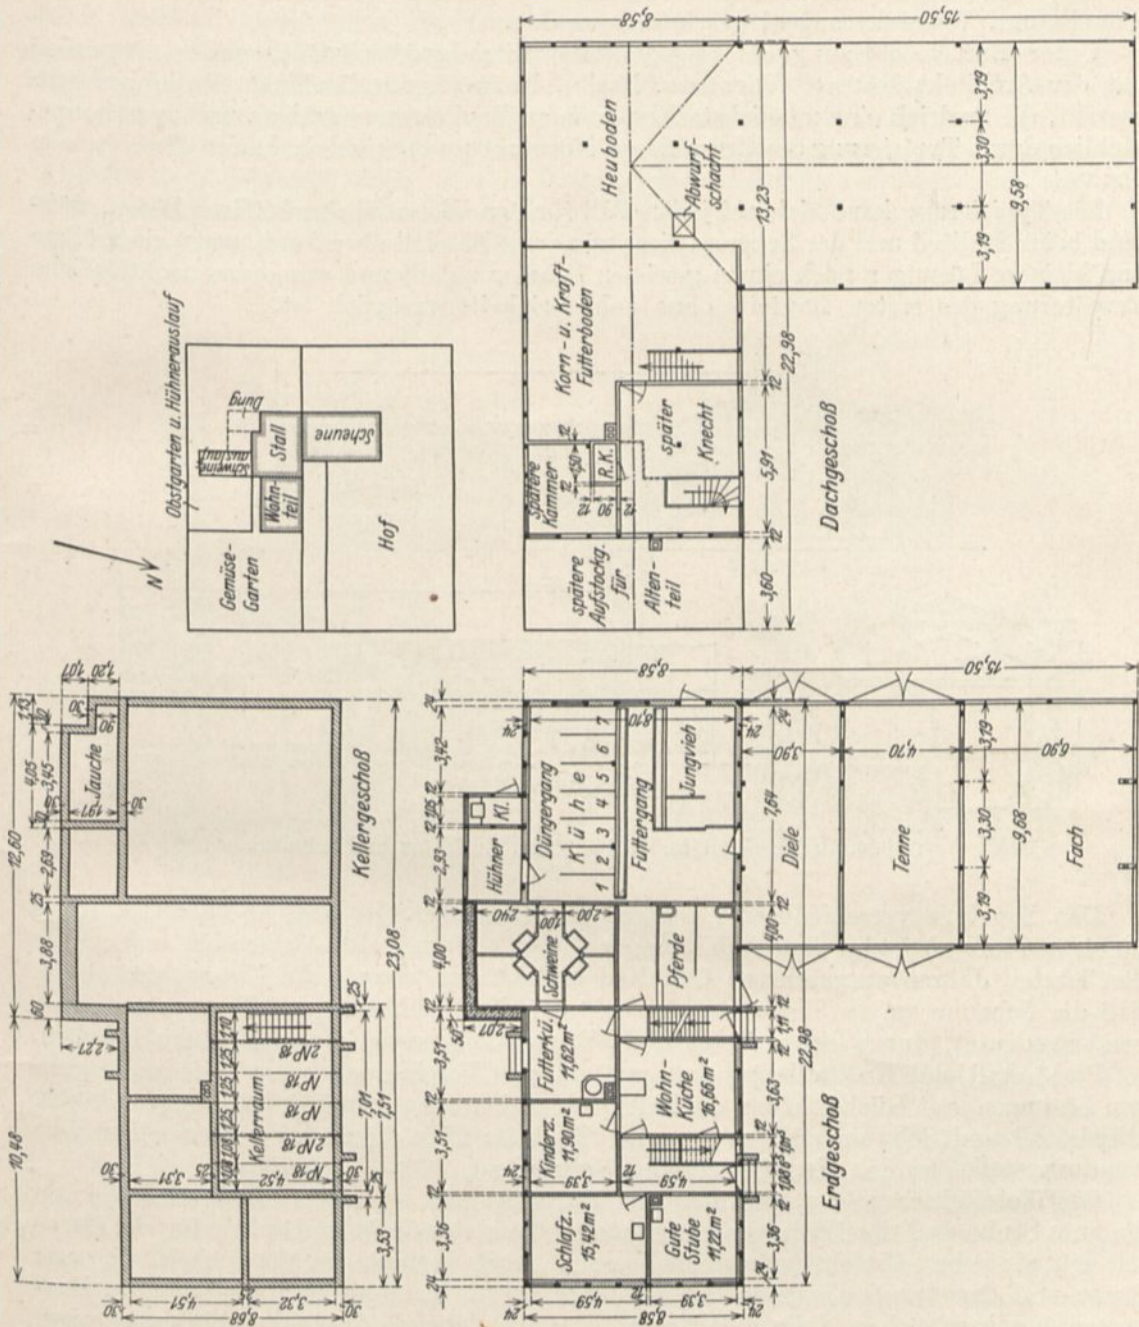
Bauerngehöft für 15 bis 20 ha nach dem Entwurf von Bruno Ahrends. Grundrisse.
